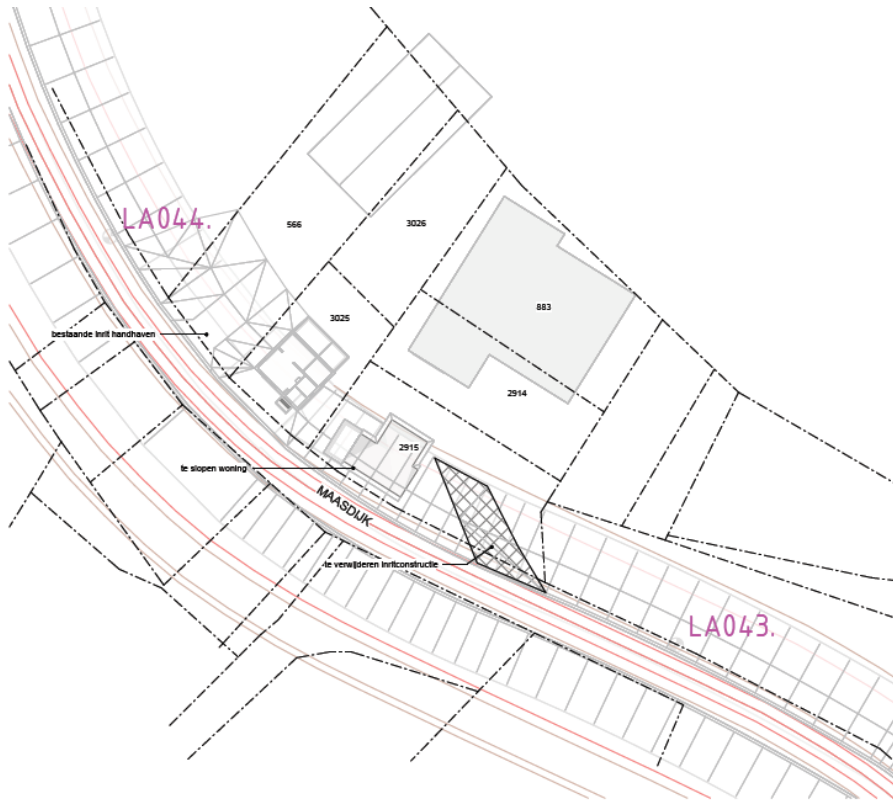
Uitsnede Legger Waterkeringen
